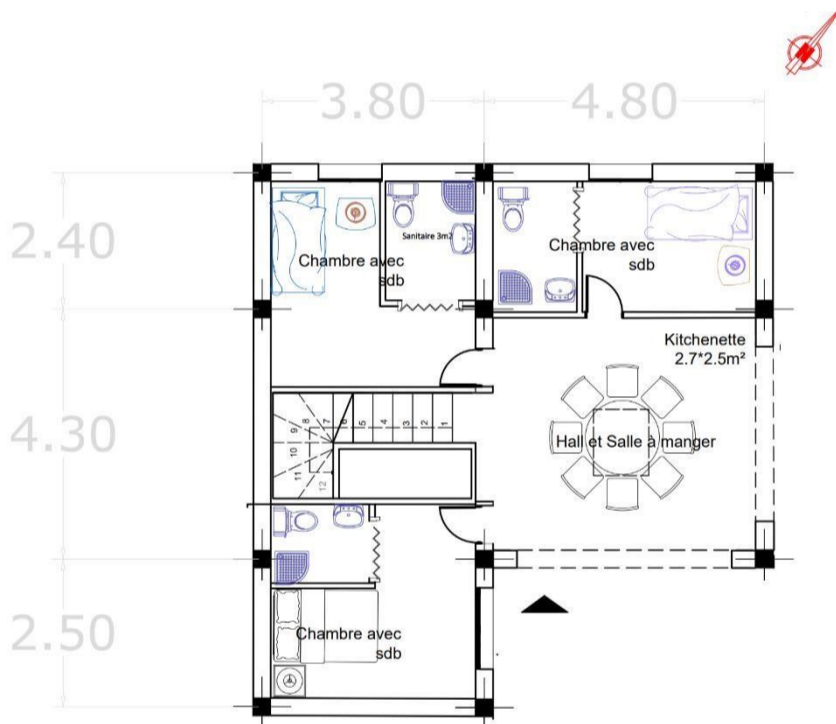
plan rdc hébergement type 2 source : traité par auteur
